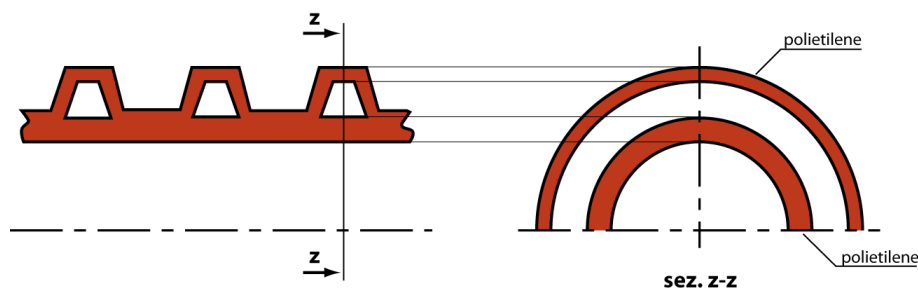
sezione di una tubazione corrugata a doppia parete (tipo B secondo EN 13476-3: 2007)
